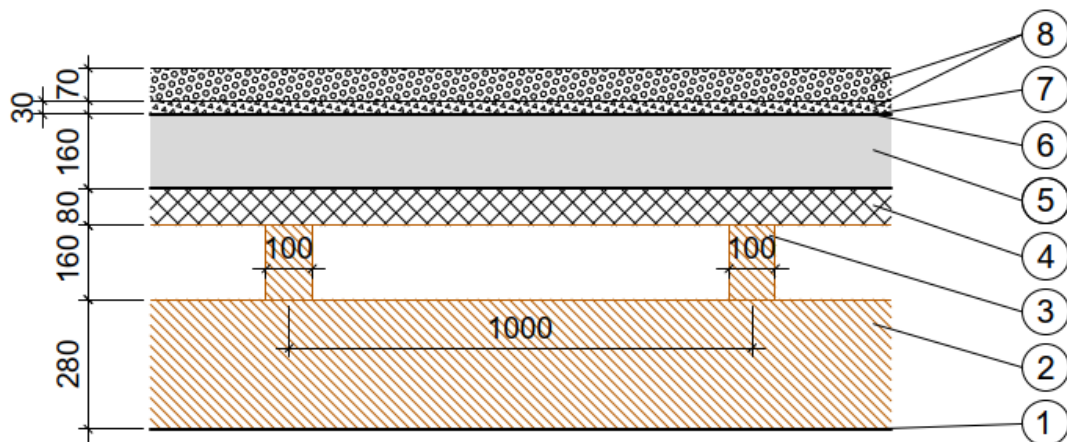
Aufbau Holz-Beton-Verbunddach (Holzbalken)
